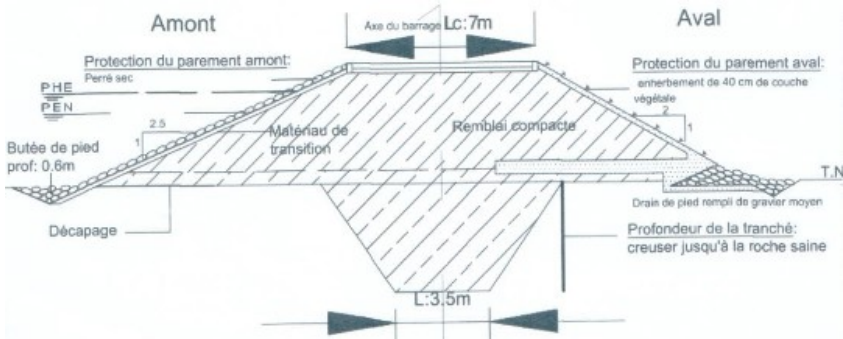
Profil en travers de la digue piste (tranché d'ancrage central)
